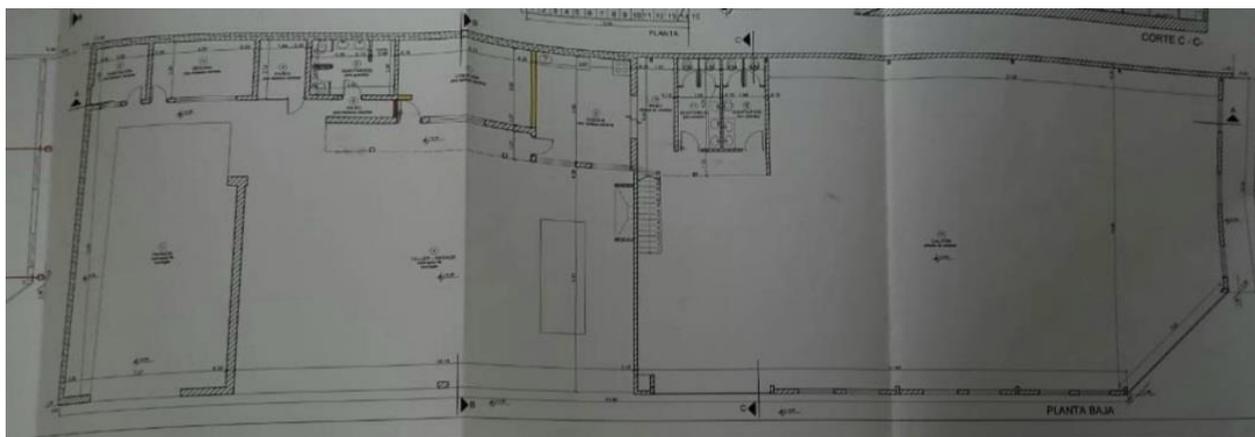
Imagen planta de planos visados Cuartel de Bomberos.
